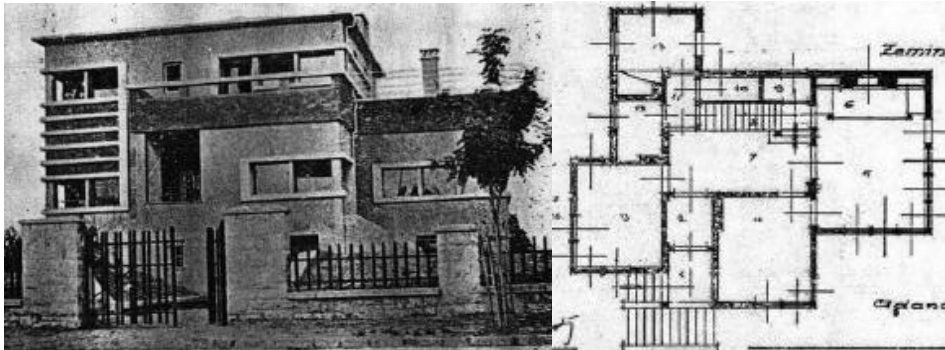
Bekir Bey evi görünüşü ve planı
